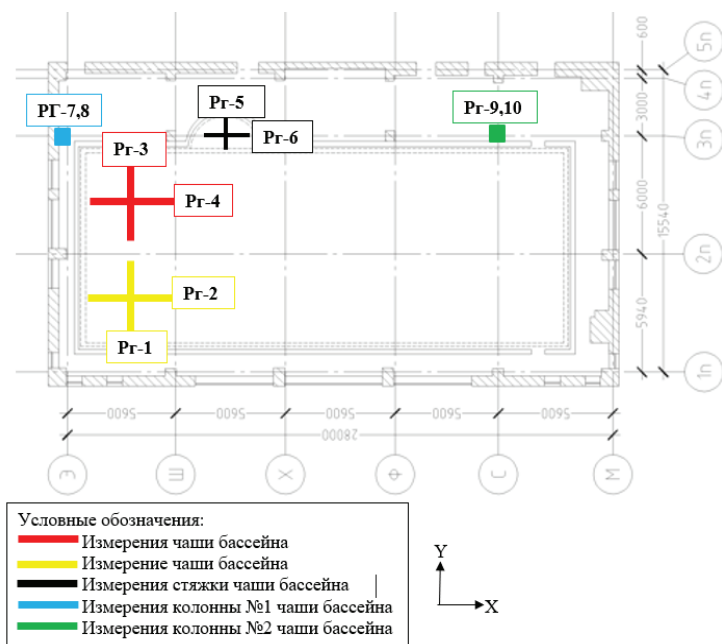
План - схема 1 этажа здания (корпуса №95)
